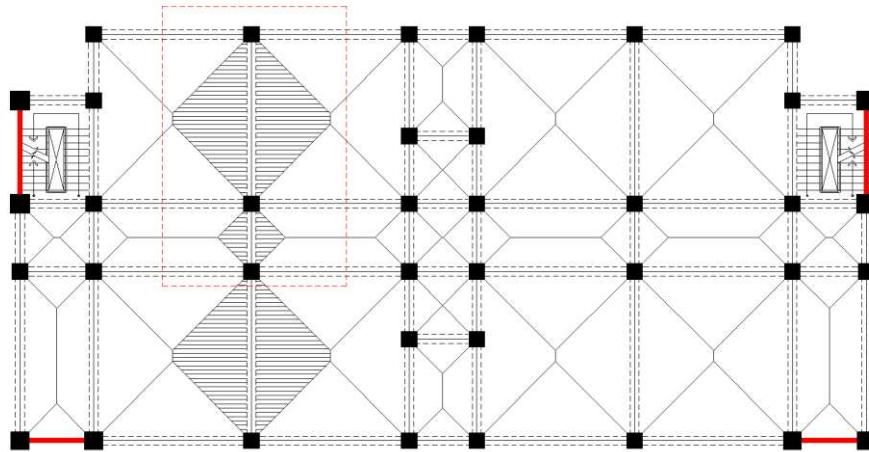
Denah Potongan Beban Portal As 2 Arah X
